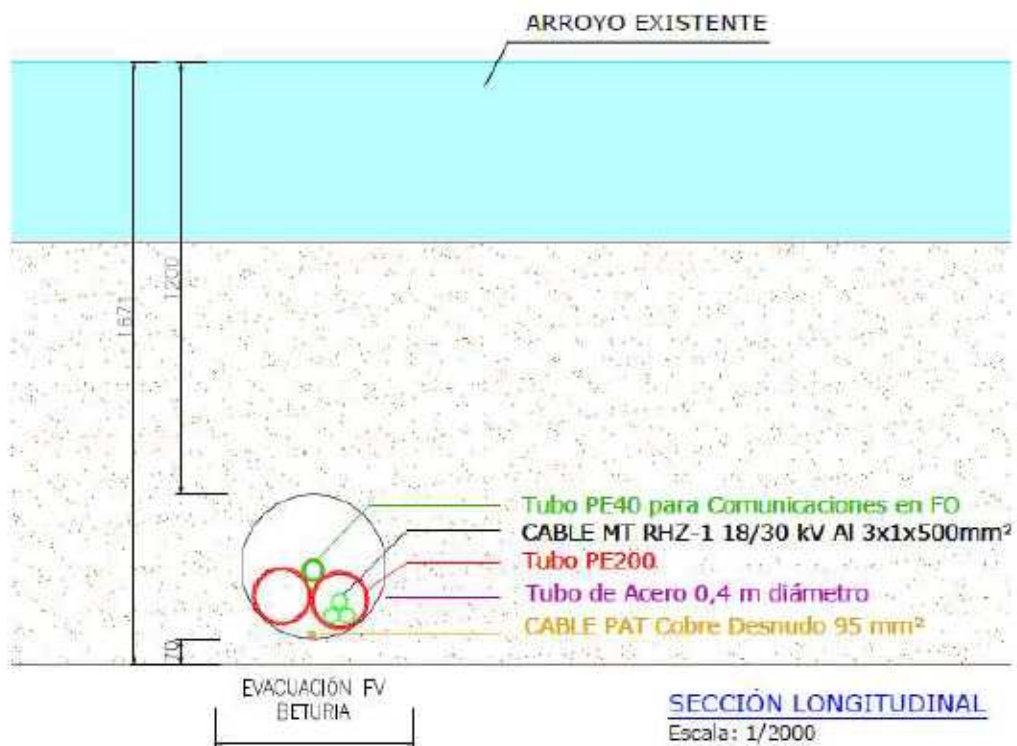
Sección longitudinal del cruce de línea de MT con Arroyo inominado.
